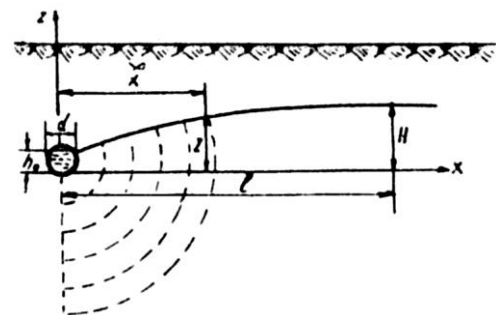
Dren situat la distanță mare față de stratul impermeabil. Cazul II.
